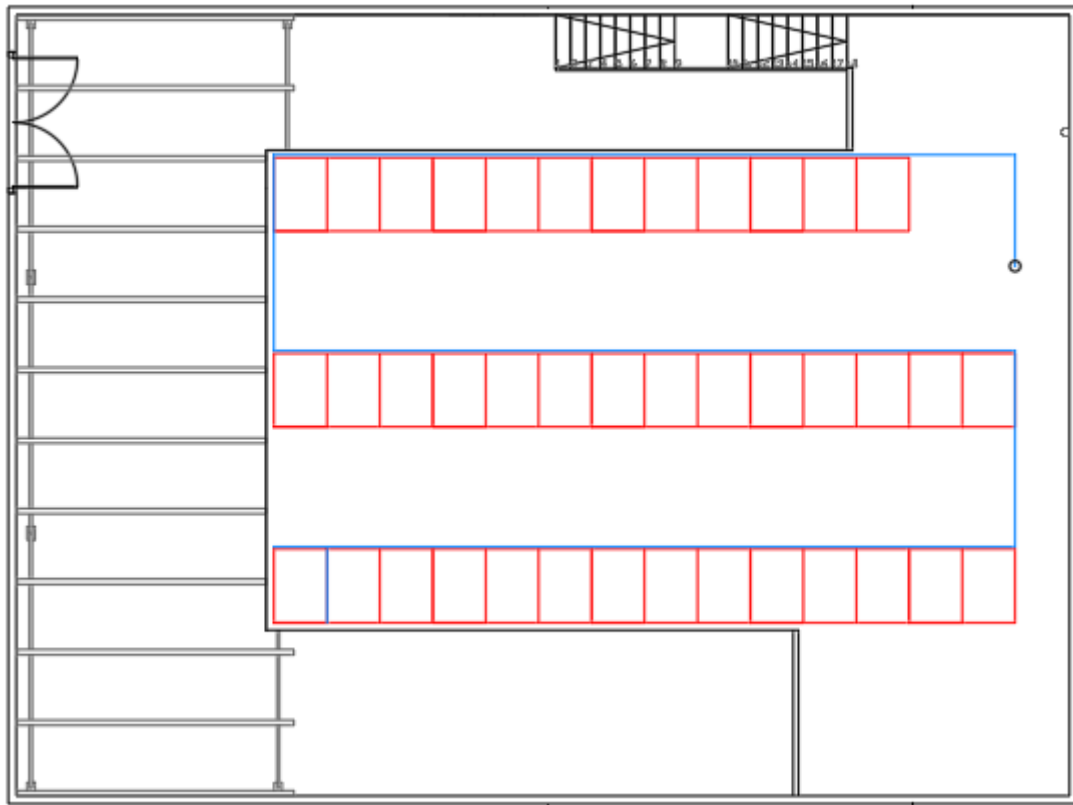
Disposición de la instalación fotovoltaica sobre el tejado (en rojo) y conductor que une la instalación (en azul).
